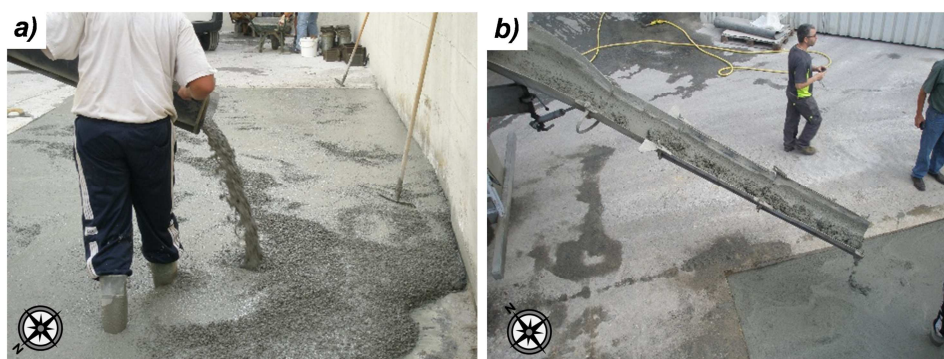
20 – a) puesta en obra y; b) final del vertido del hormigón
